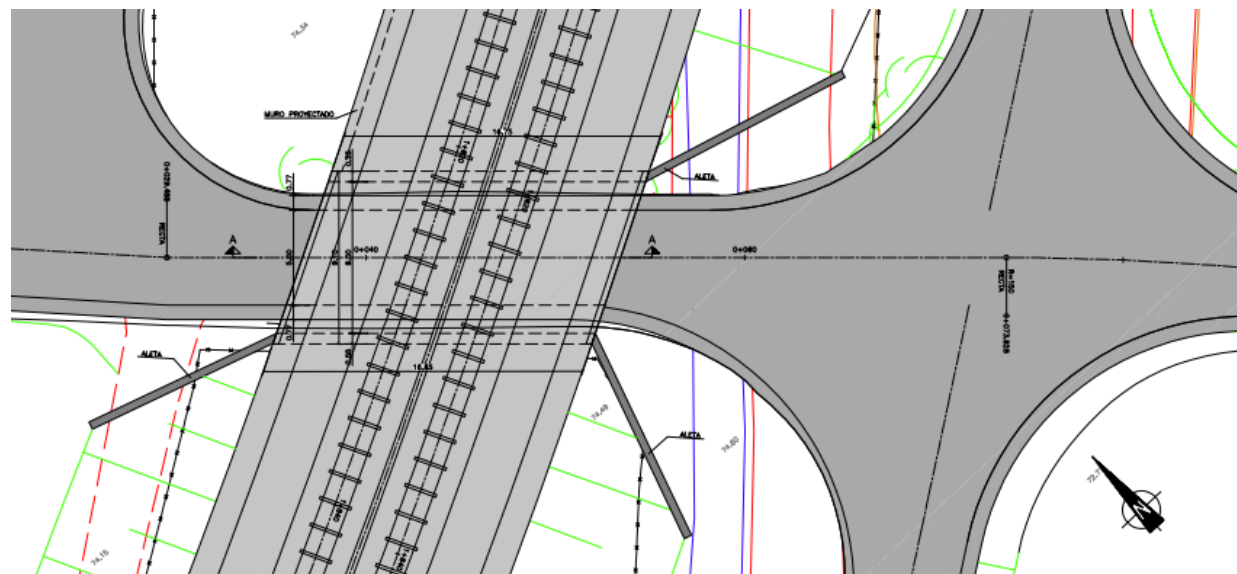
PLANTA PI CAMINO P.K. 1+820
